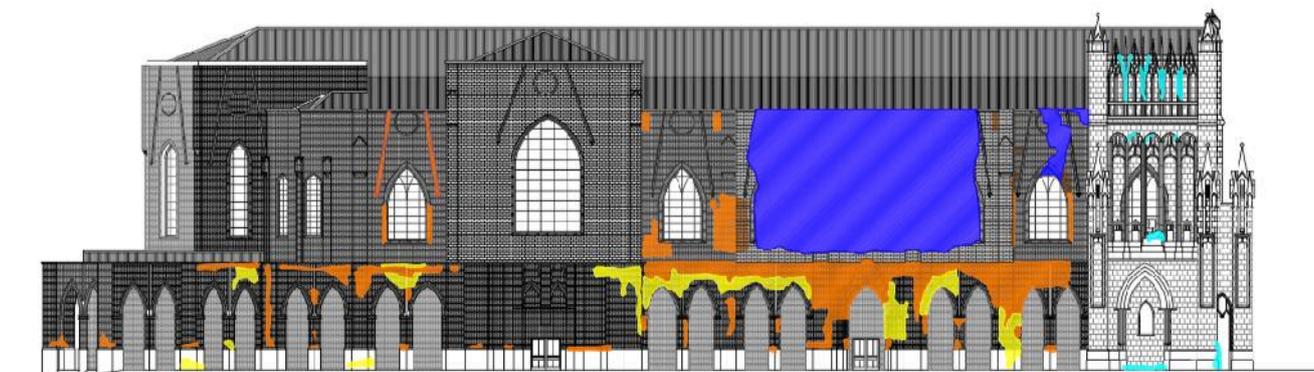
Fachada Poniente de la Basílica del Salvador.
